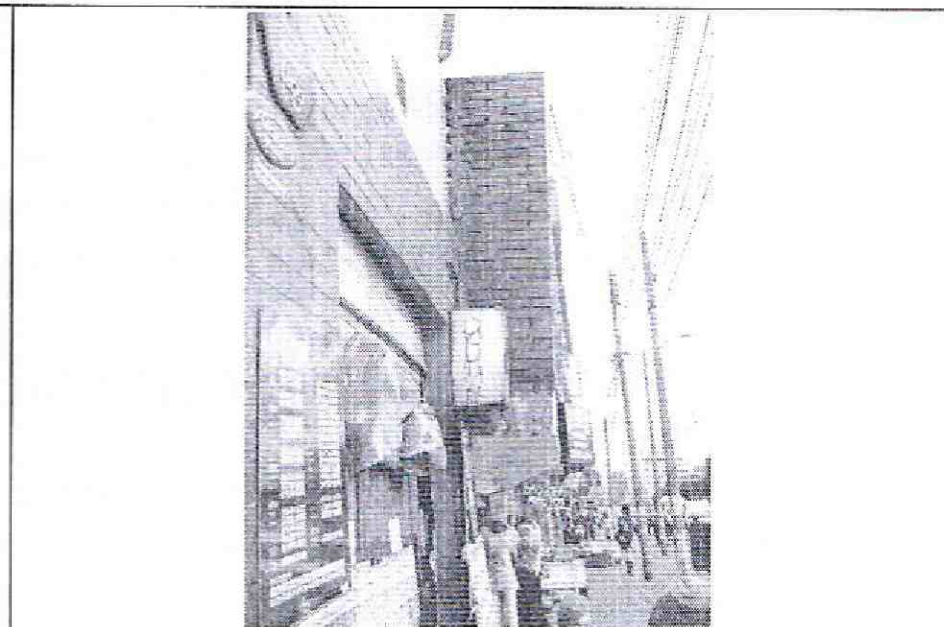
Vista lateral. El muro de fachada del segundo piso evidencia inclinación con tendencia hacia la vía
